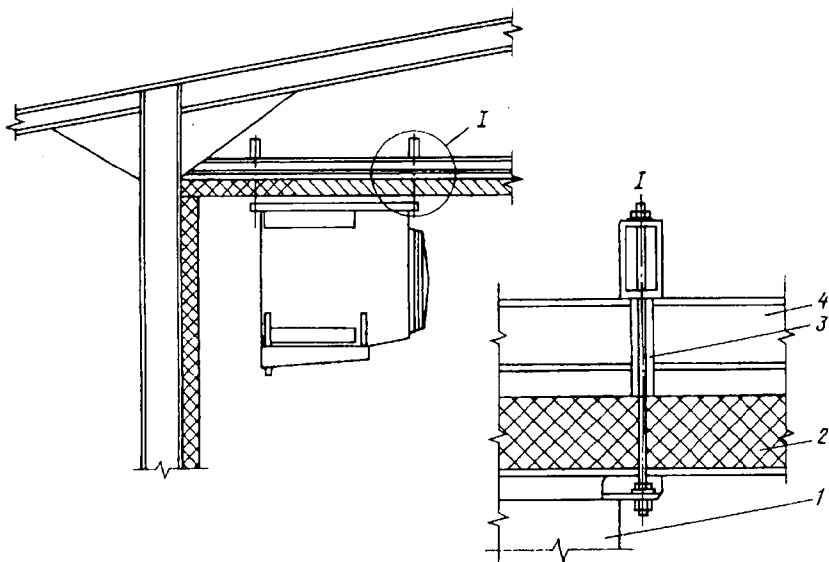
Крепление подвешного воздухоохладителя к металлическим несущим конструкциям:
